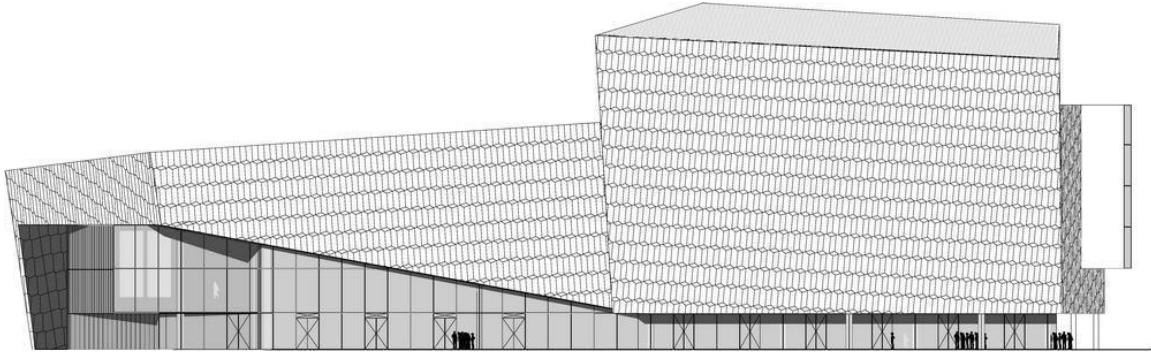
Elevación arquitectónica de fachada sur del Auditorio y Centro de Conferencias *Harpa*.
